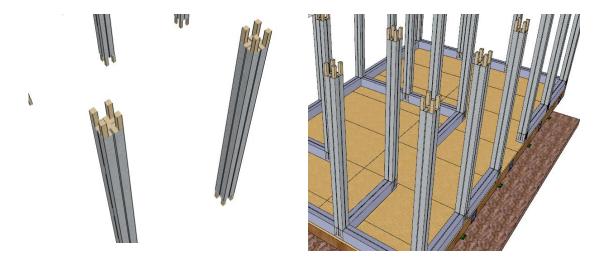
Columna en madera pino pátula forrada por una lámina de acero galvanizado unida a la solera inferior.
